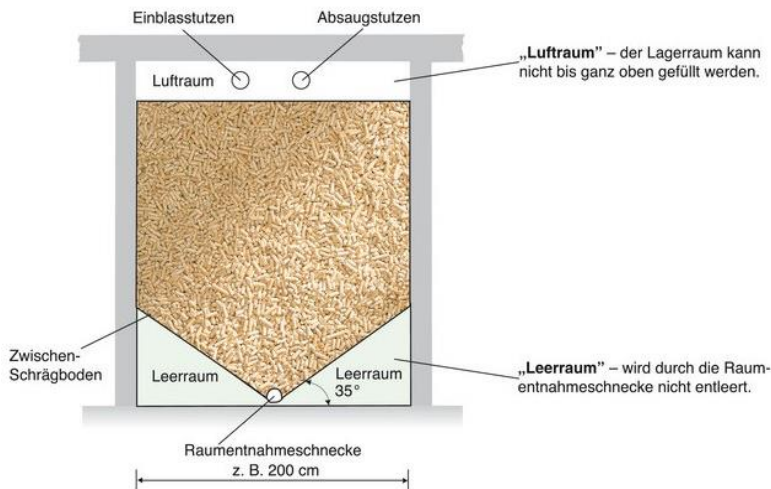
Querschnitt für einen Pellet-Lagerraum. Quelle: Ökofen Heiztechnik GmbH
